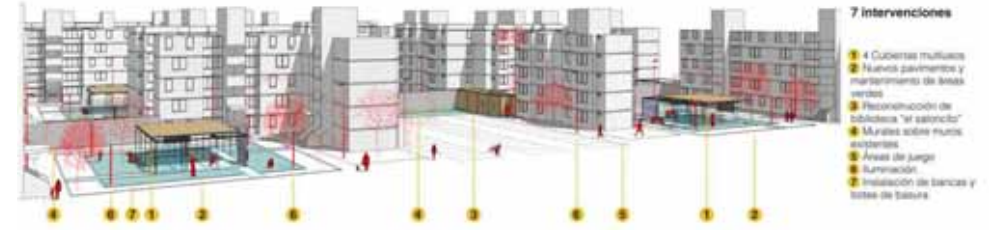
Zonas y mobiliario intervenido en el proyecto
